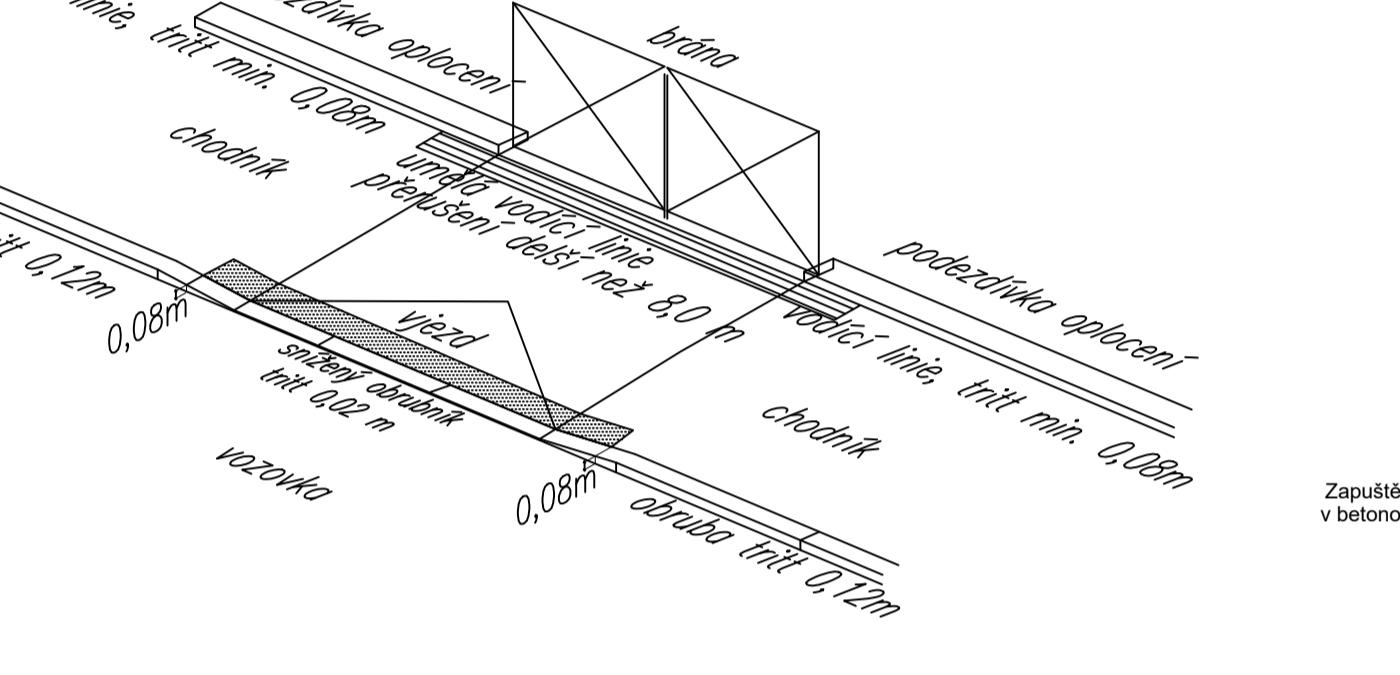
DETAIL VJEZDU - IZOMETRICKÝ POHLED
